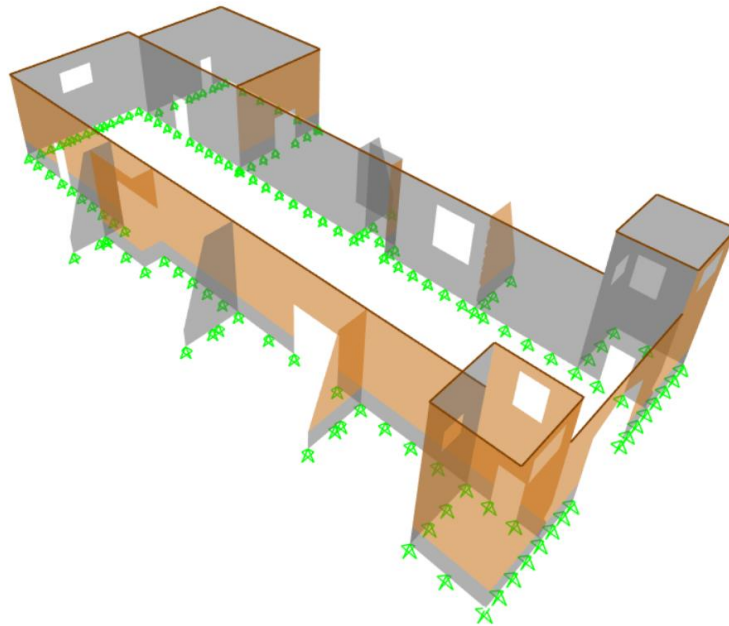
Ubicación del refuerzo de viga collar en el modelo estructural.
